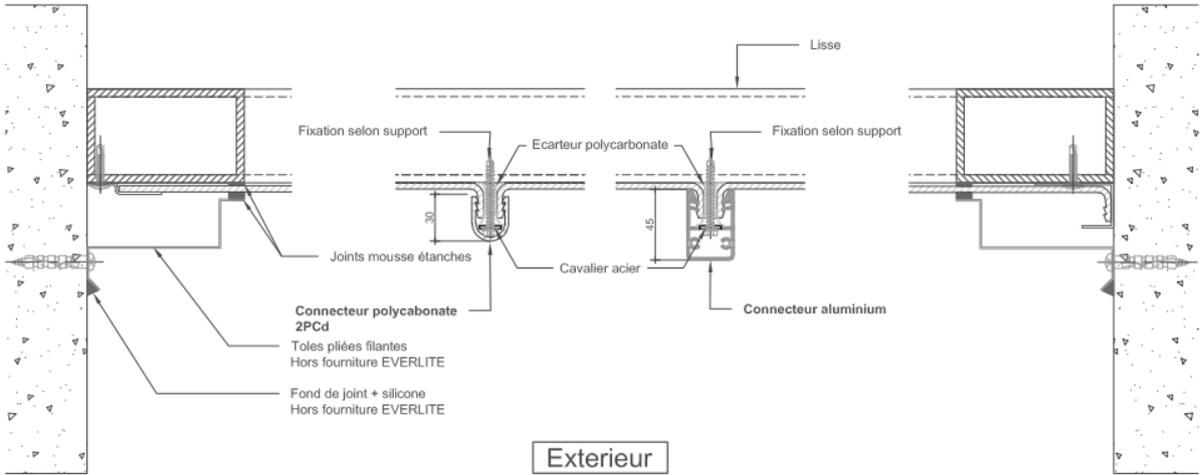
Système DANPALITE Façade / SHED - Coupe horizontale
